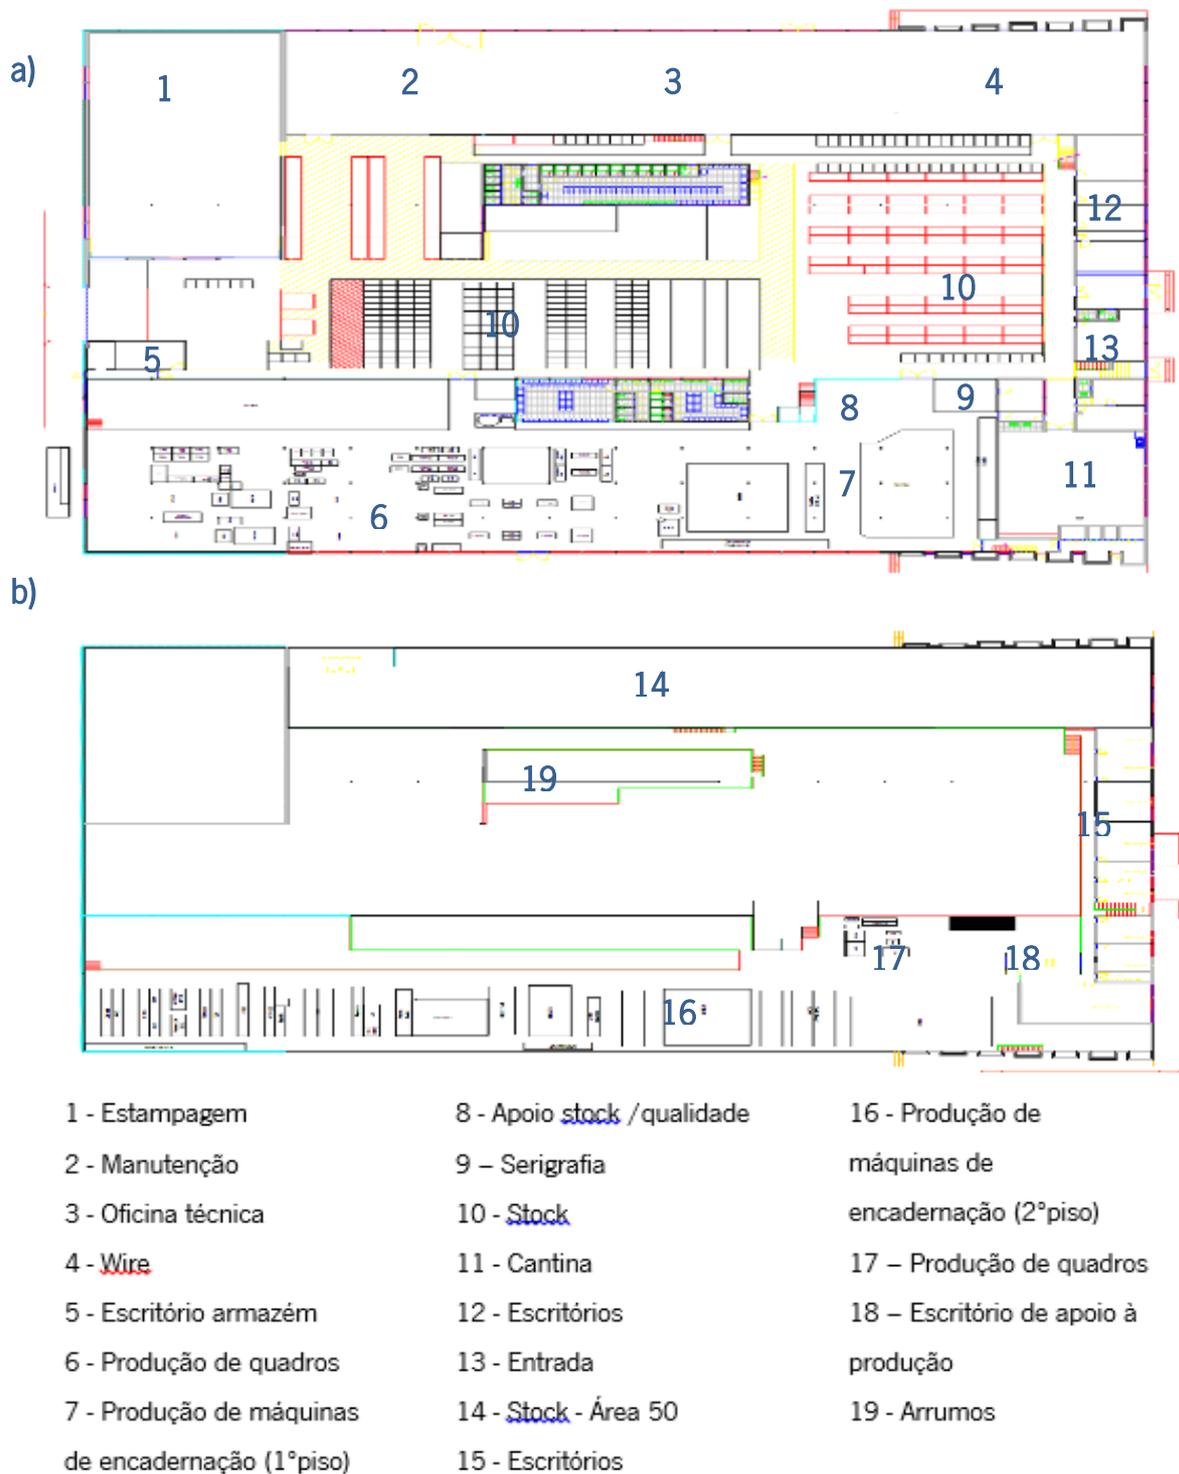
Planta da ACCO Brands: a) Piso Inferior, b) Piso Superior
